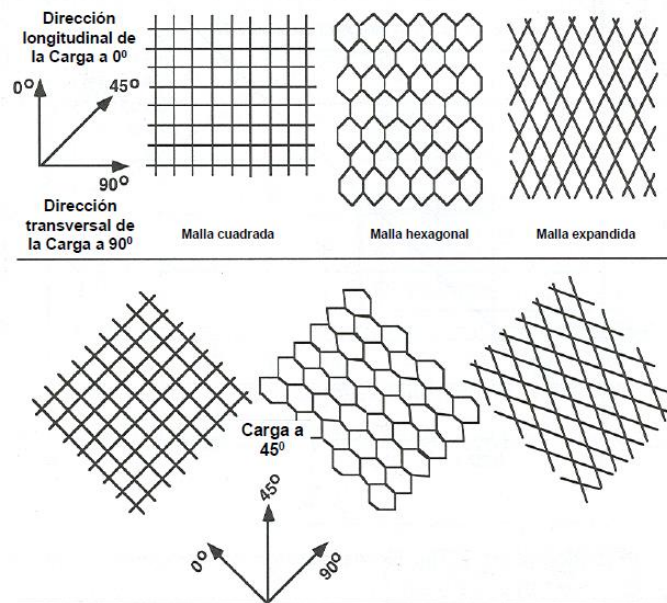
Dirección de la carga y orientación de las mallas de refuerzo.
